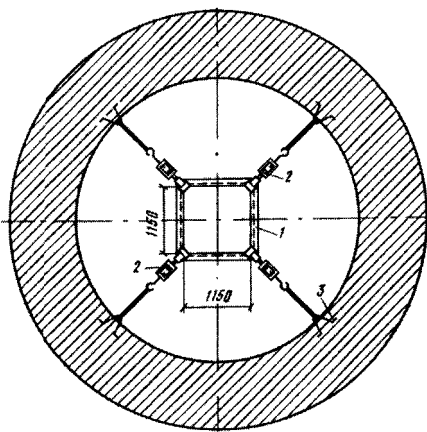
Расположение гибких связей и скоб для крепления шахты подъемника:
